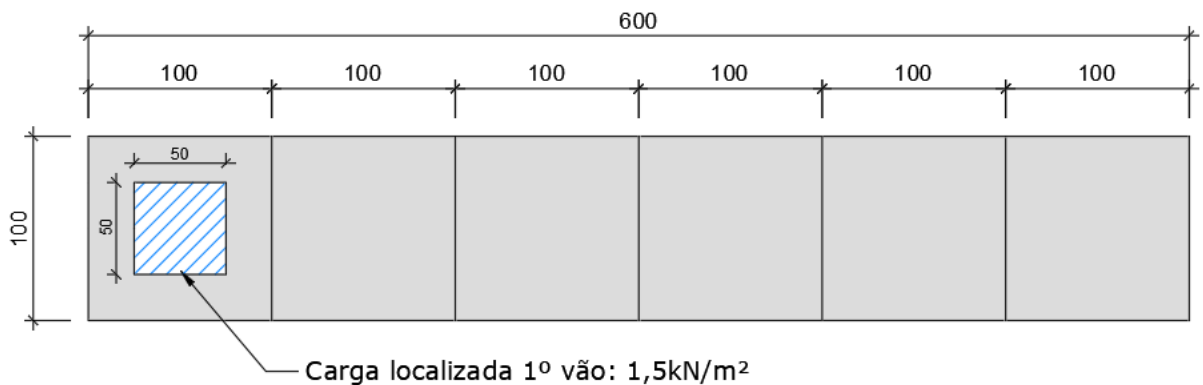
Aplicação de carga para telhas com 2m entre apoios
